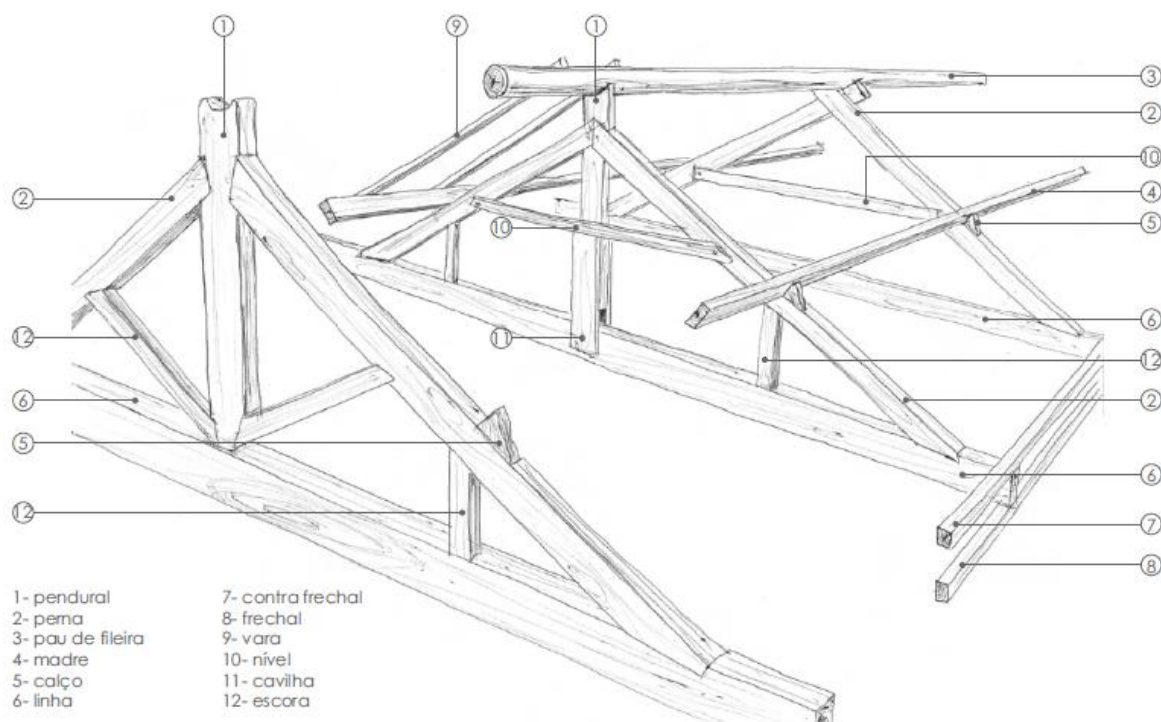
Pormenor tipo da estrutura da cobertura (fonte: Moutinho (2007))
